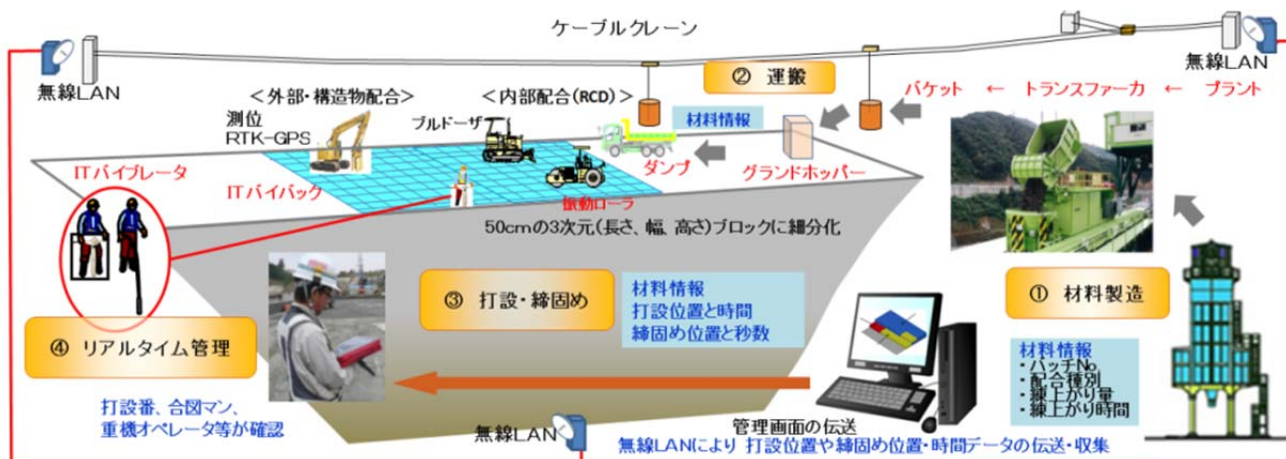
コンクリートトレースシステムの構成（伊良原ダム）
